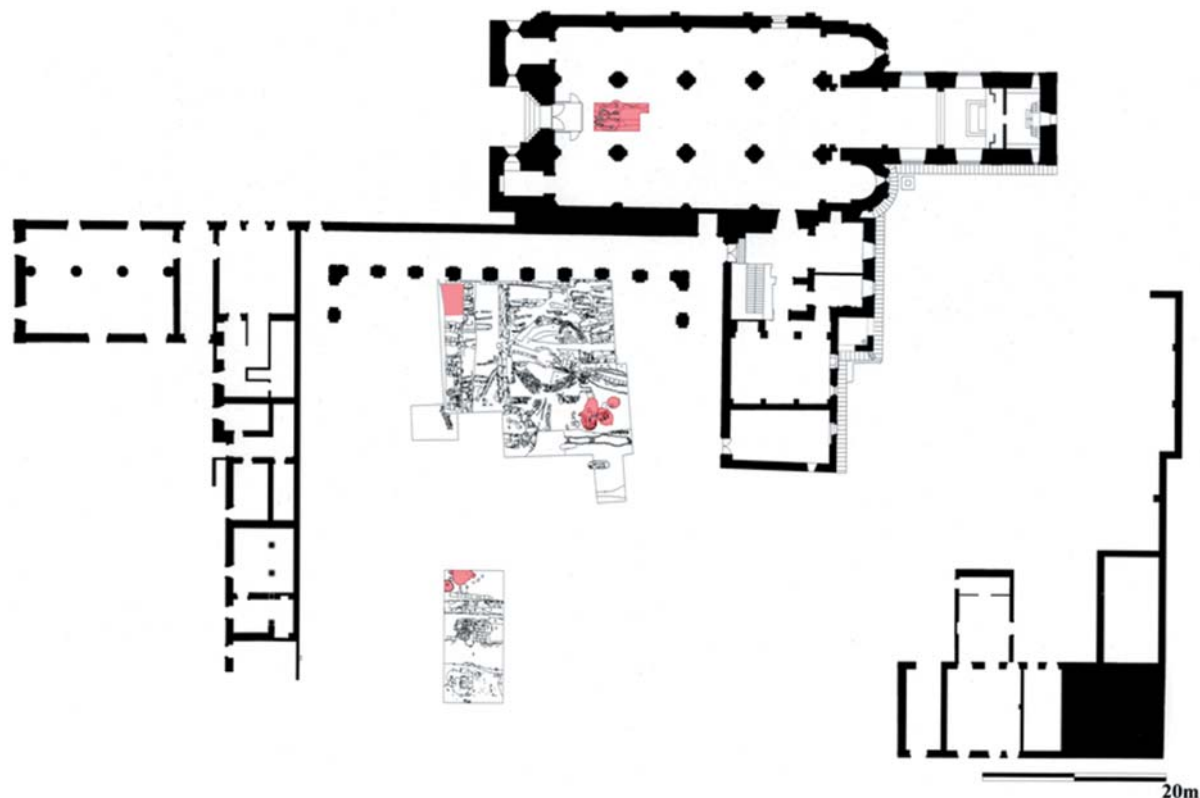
Planta de localização dos fossos de fundição. Ricardo Erasun.
